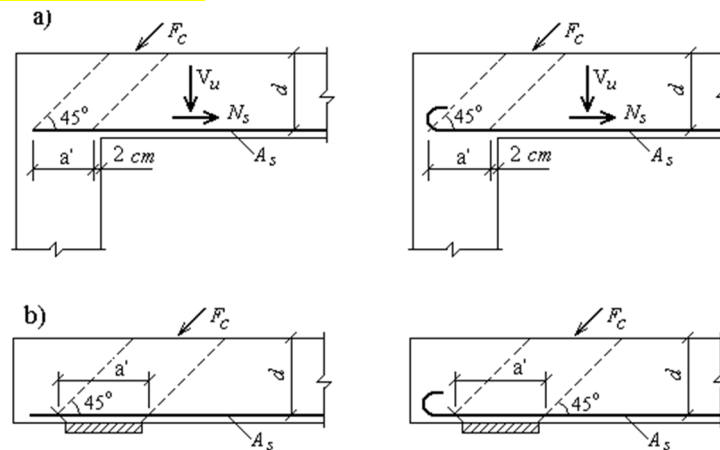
a - poutre à nervure rectangulaire reposant sur un poteau ou sur un mur; b - poutre à nervure rectangulaire reposant sur un appareil d'appui
